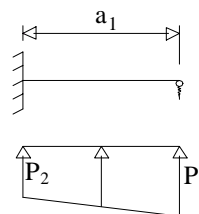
Comprimento da viga engastada e apoiada em apoio elástico
